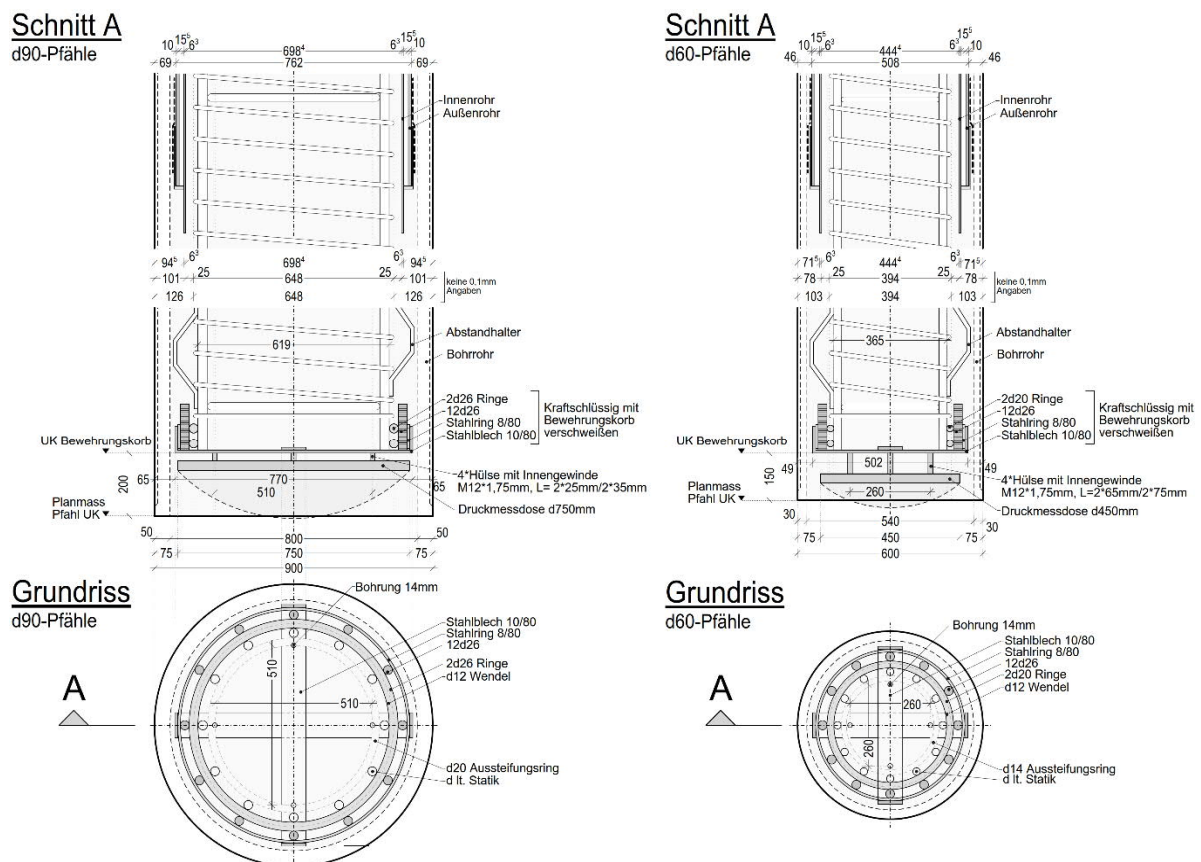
Montage Druckmessdose - Pfahlfuß, Planausschnitt aus [75]
